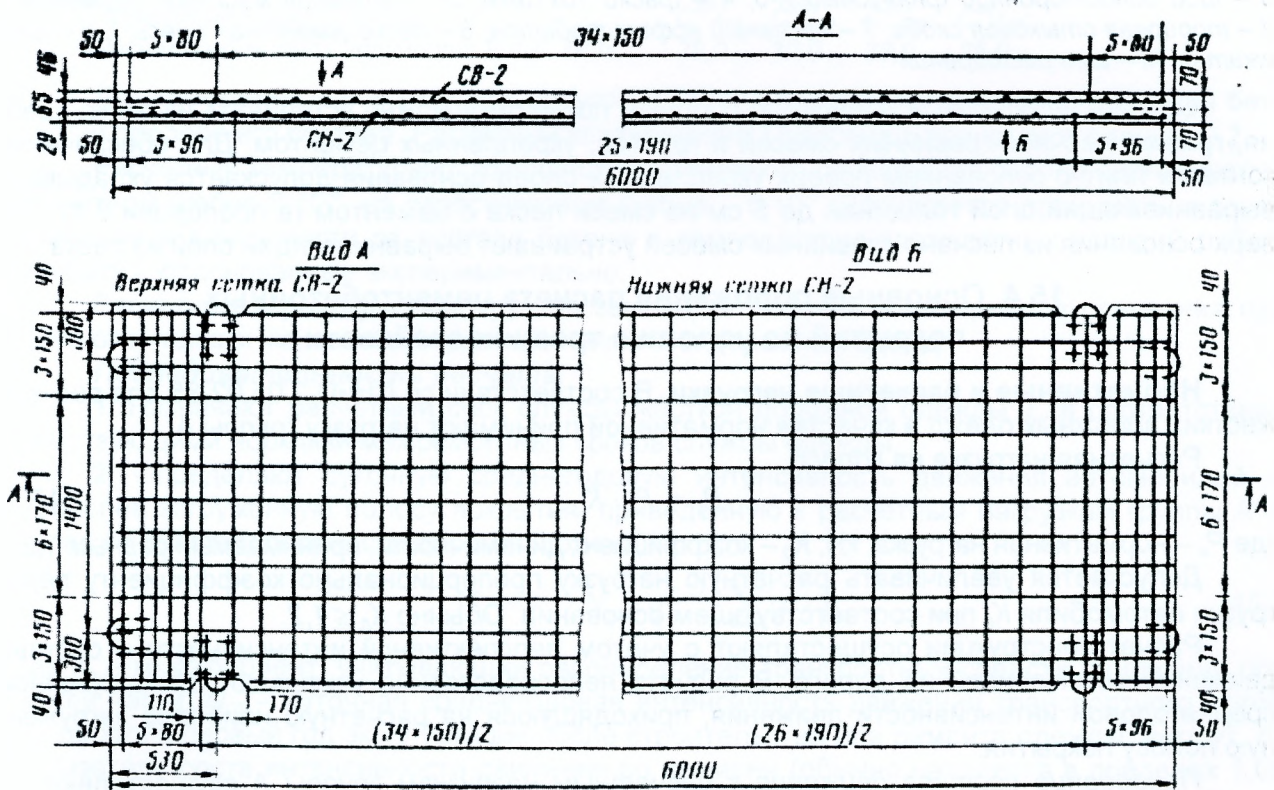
Конструкция железобетонной плиты ПДО сборного дорожного покрытия. Рабочая продольная арматура класса S400 марки 25Г2С
